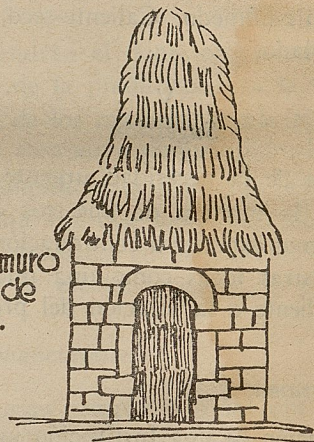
jacal con muro de adobe. Linteles de madera o piedra.
